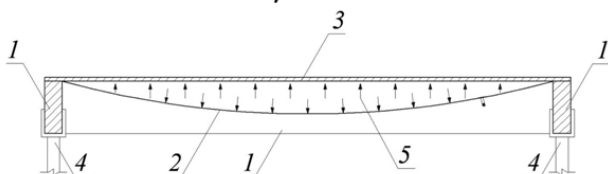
Принципиальная схема пневматической опалубочной системы комбинированного типа. 1 — каркас щита; 2 — пневматический баллон; 3 — жесткий лист, являющийся рабочей палубой щита; 4 — опорный модуль; 5 — избыточное давление, создаваемое внутри пневматического баллона
